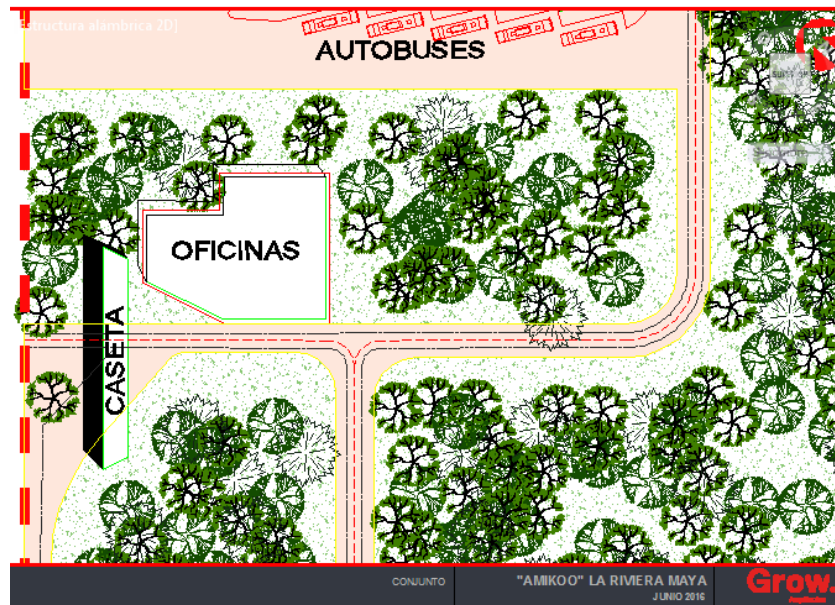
Planta de conjunto del acceso y oficinas administrativas
